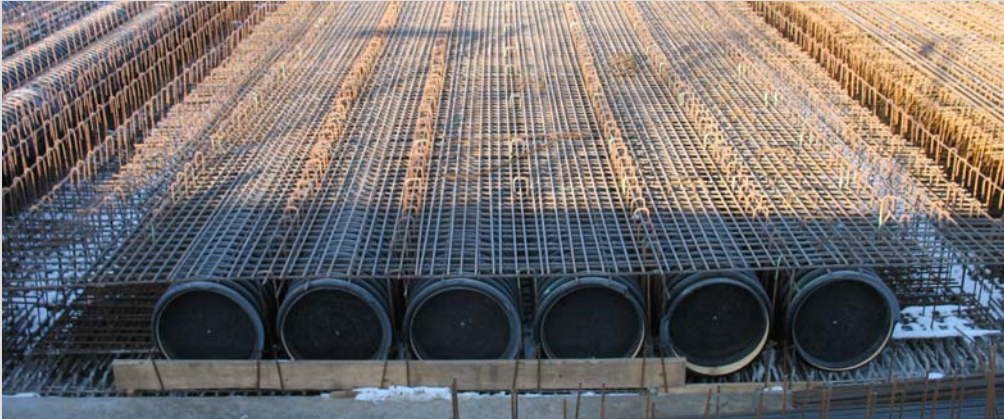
Baufortschritt – fertig gestellter Teilbereich mit Enddeckel vor dem Betonieren
